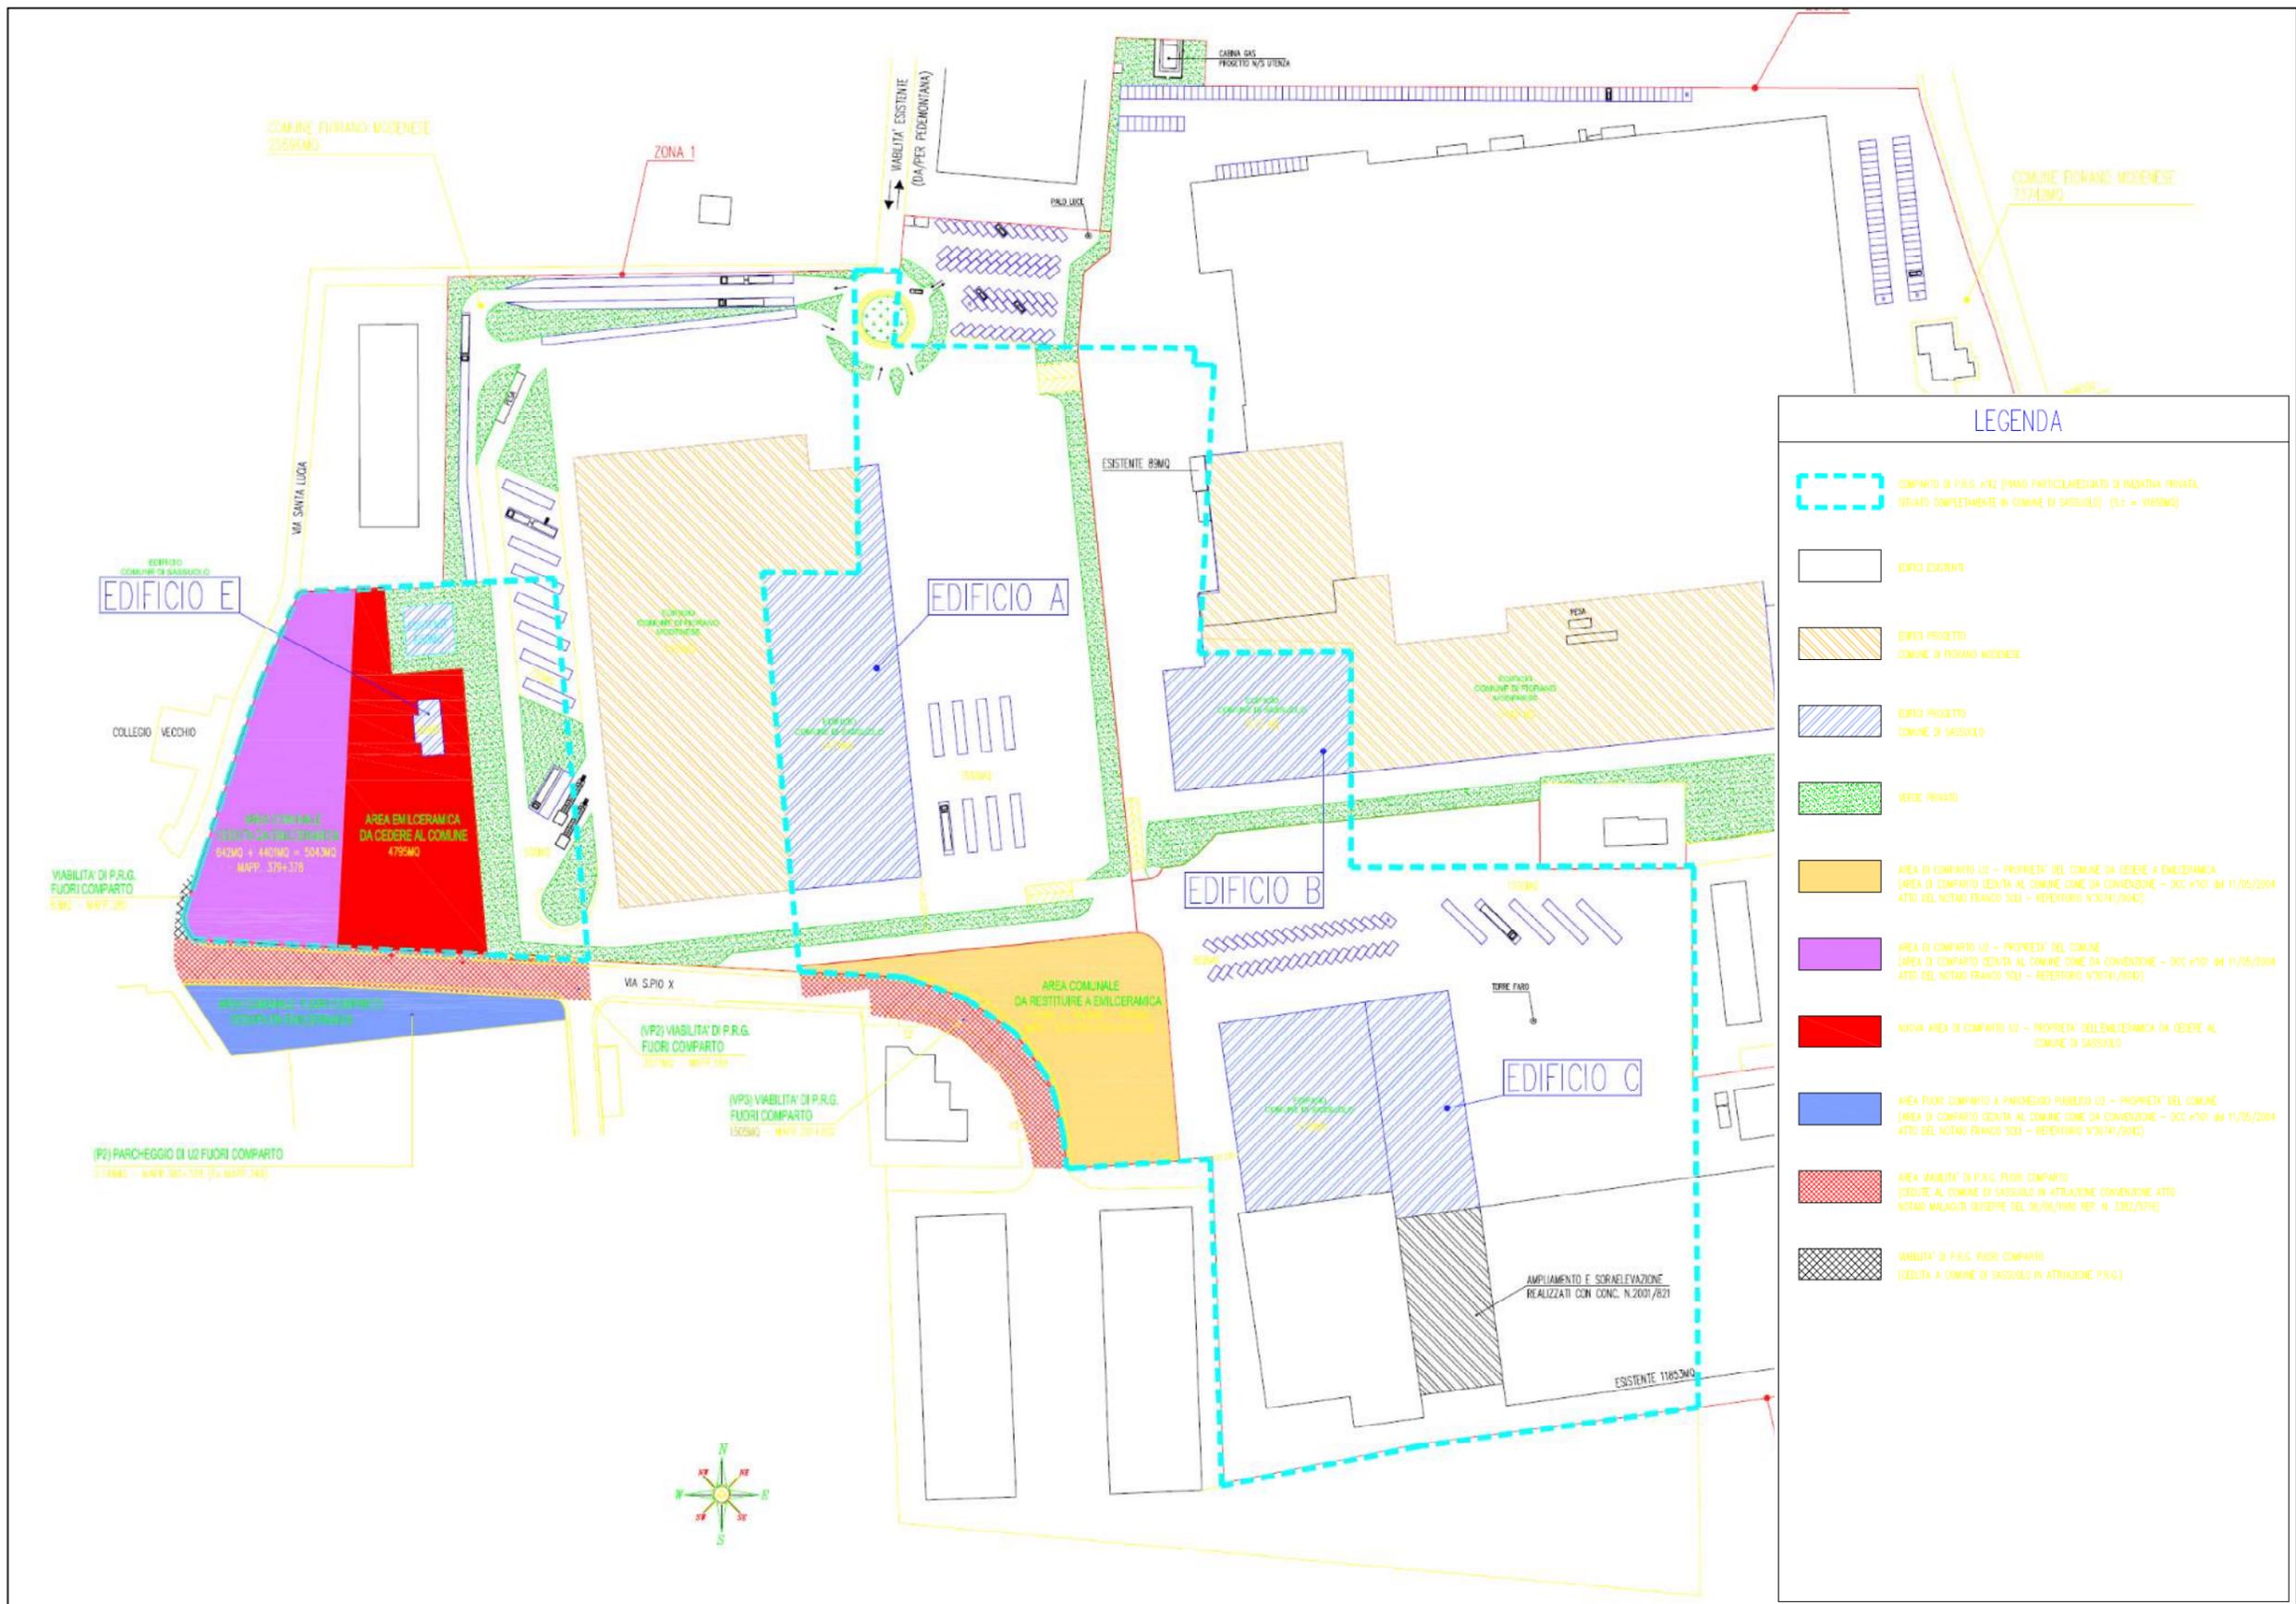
Planimetria generale di Variante con indicazione delle aree di cessione al Comune (TAV. 04 Istanza di Variante)
